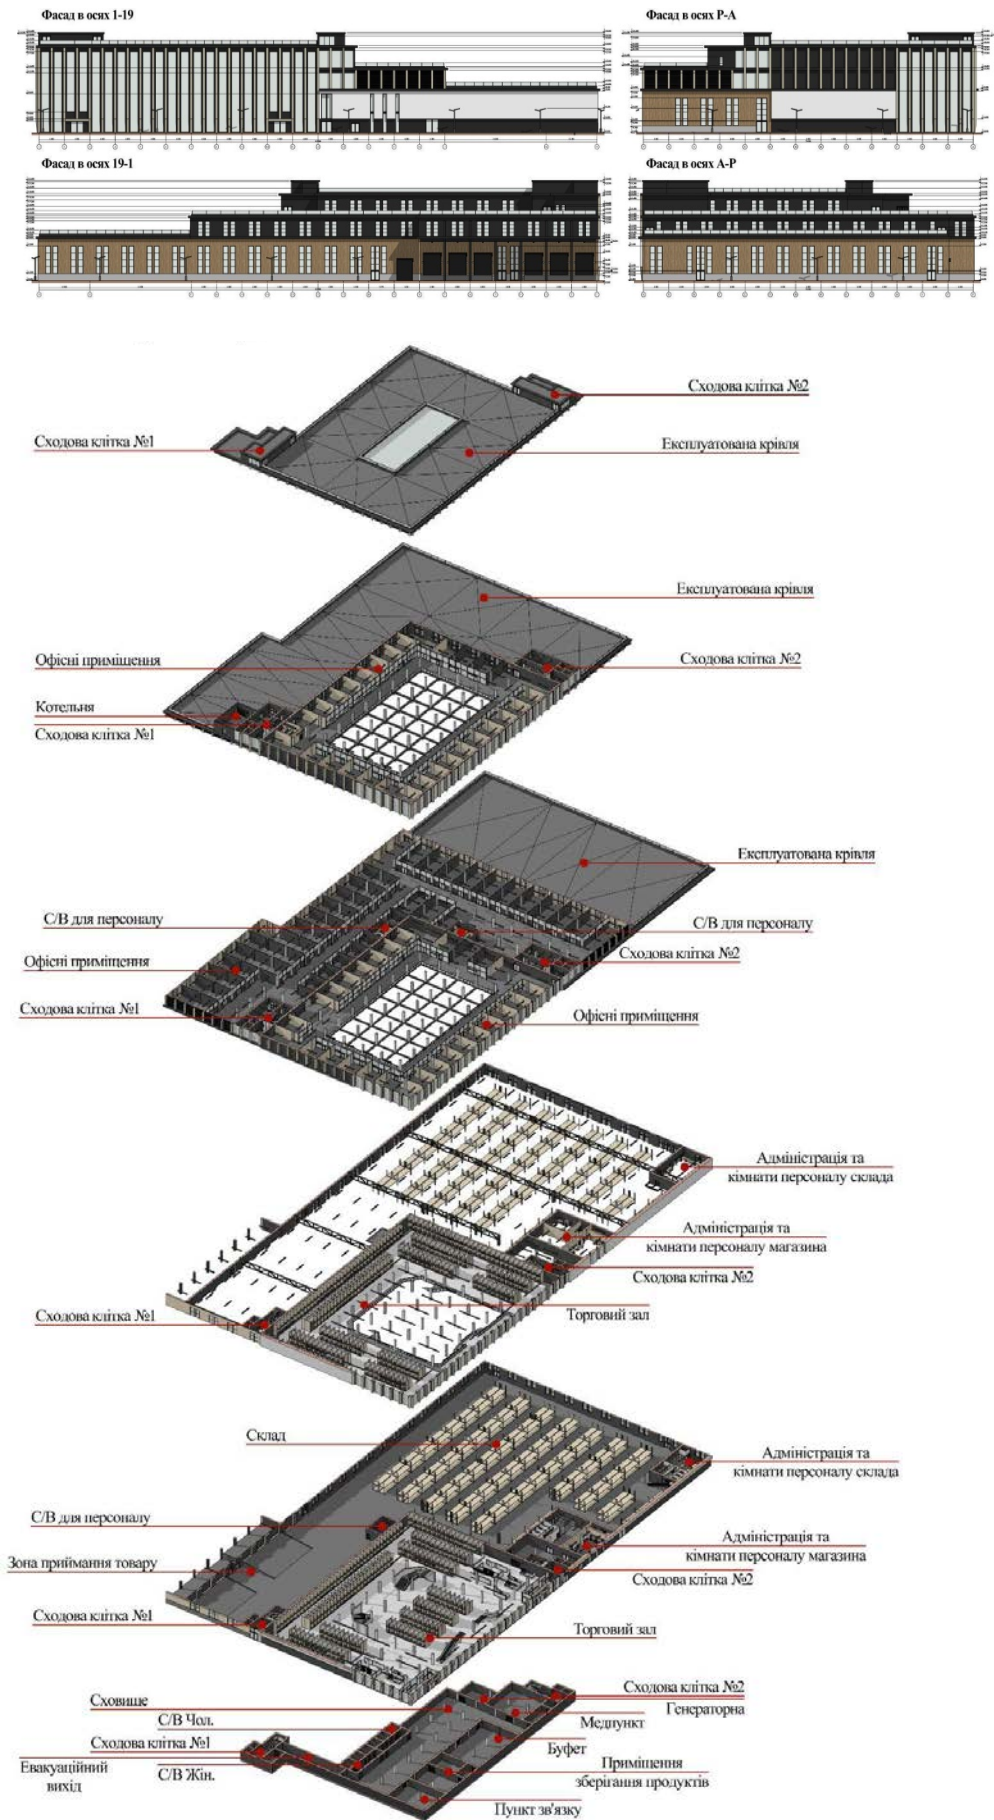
Креслення фасадів та планувальна схема будівельного хабу.
